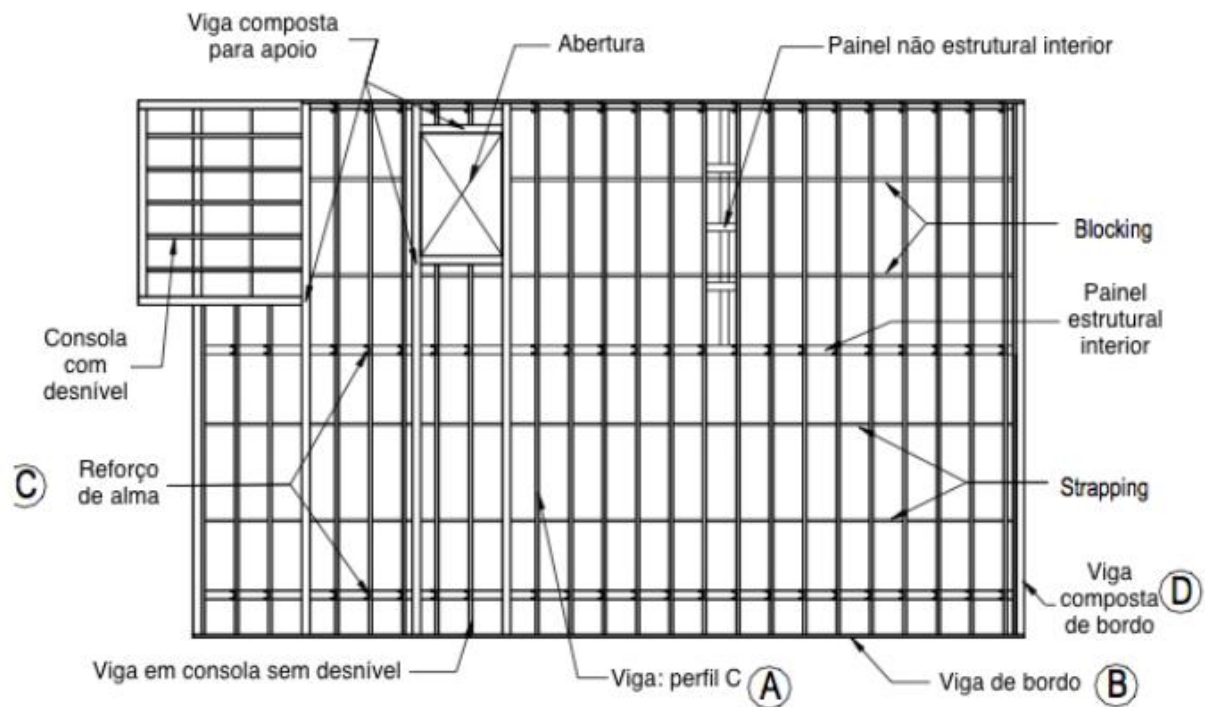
Planta dos elementos principais em LSF (Rego,2012)
